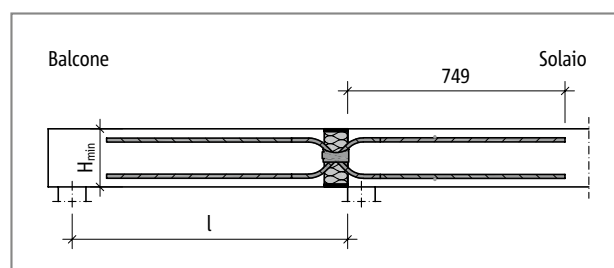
Schöck Isokorb® T tipo QP-VV7 - QP-VV9: sistema statico
